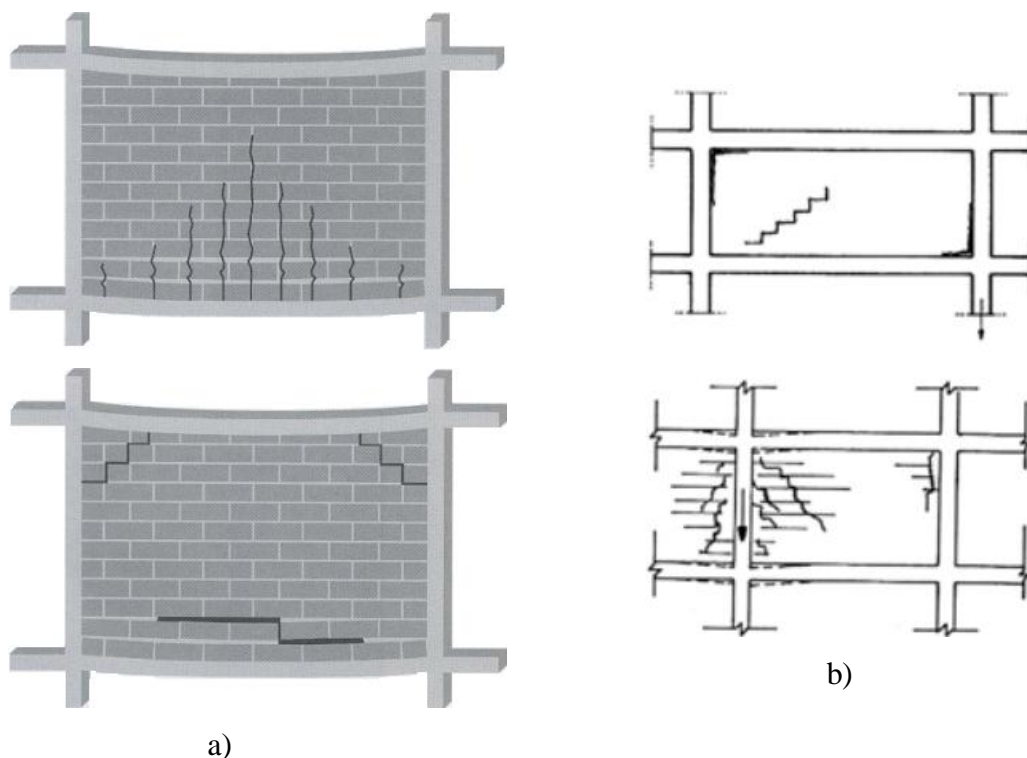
Fissuração de paredes de alvenaria não estrutural provada por deformações da estrutura de suporte (Lourenço, 2002): a) Deformações de lajes; b) Assentamento diferencial da estrutura reticulada
